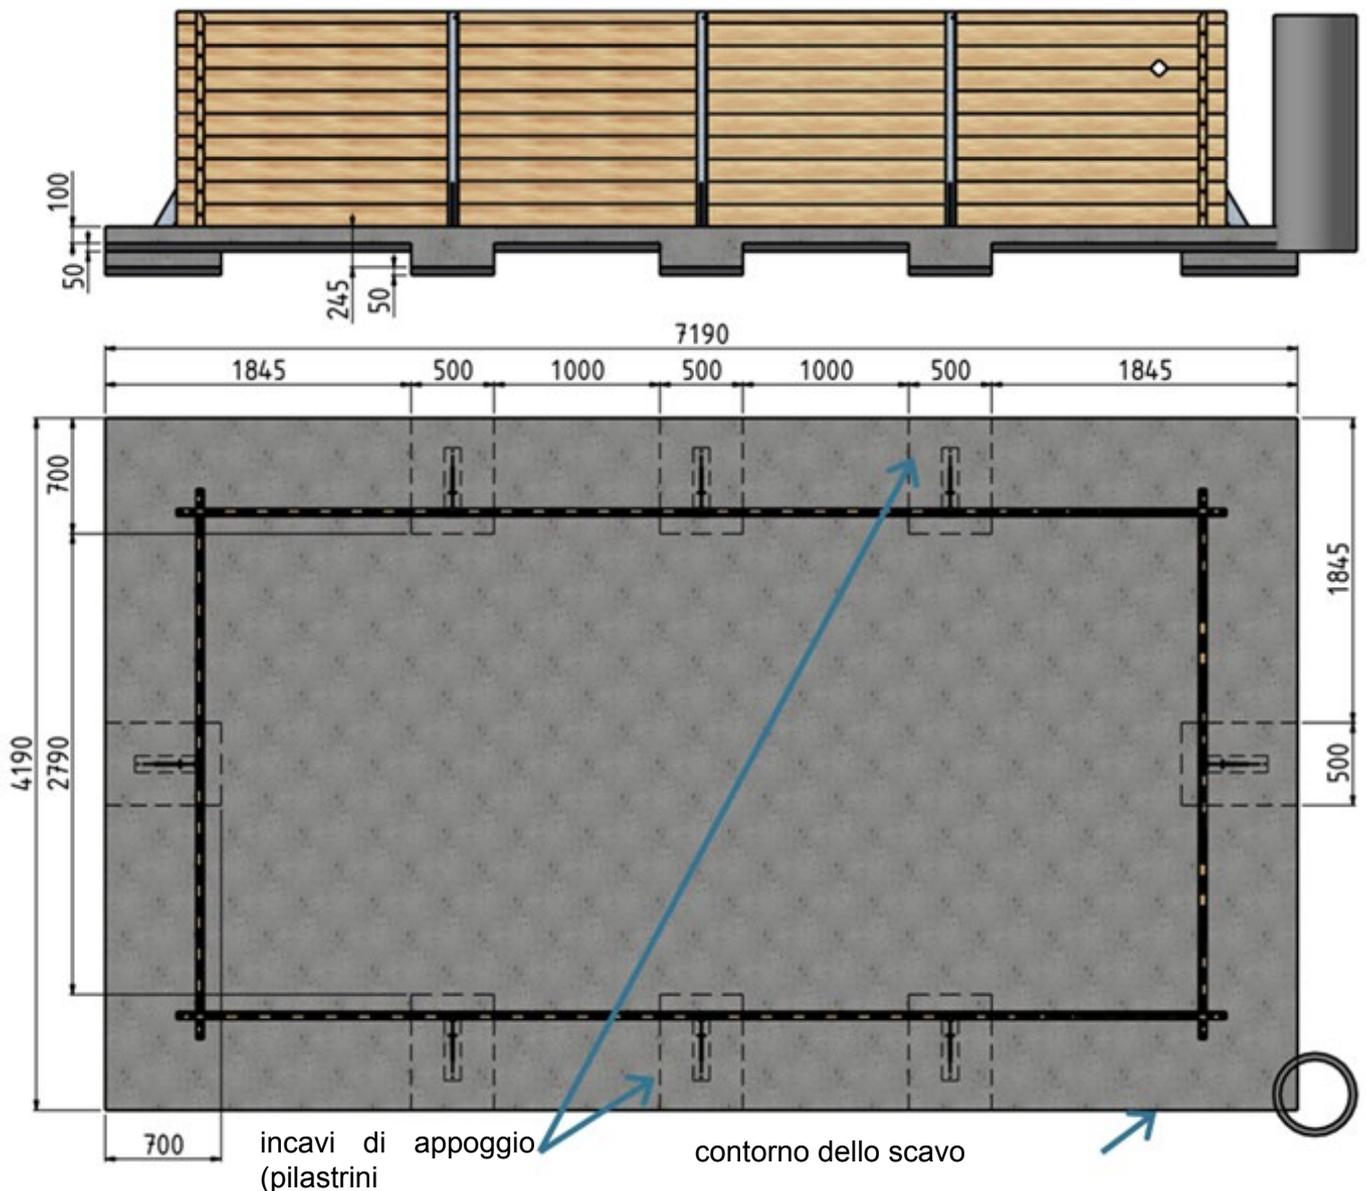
Posizioni delle cavità destinate ad accogliere i pali di fondazione
